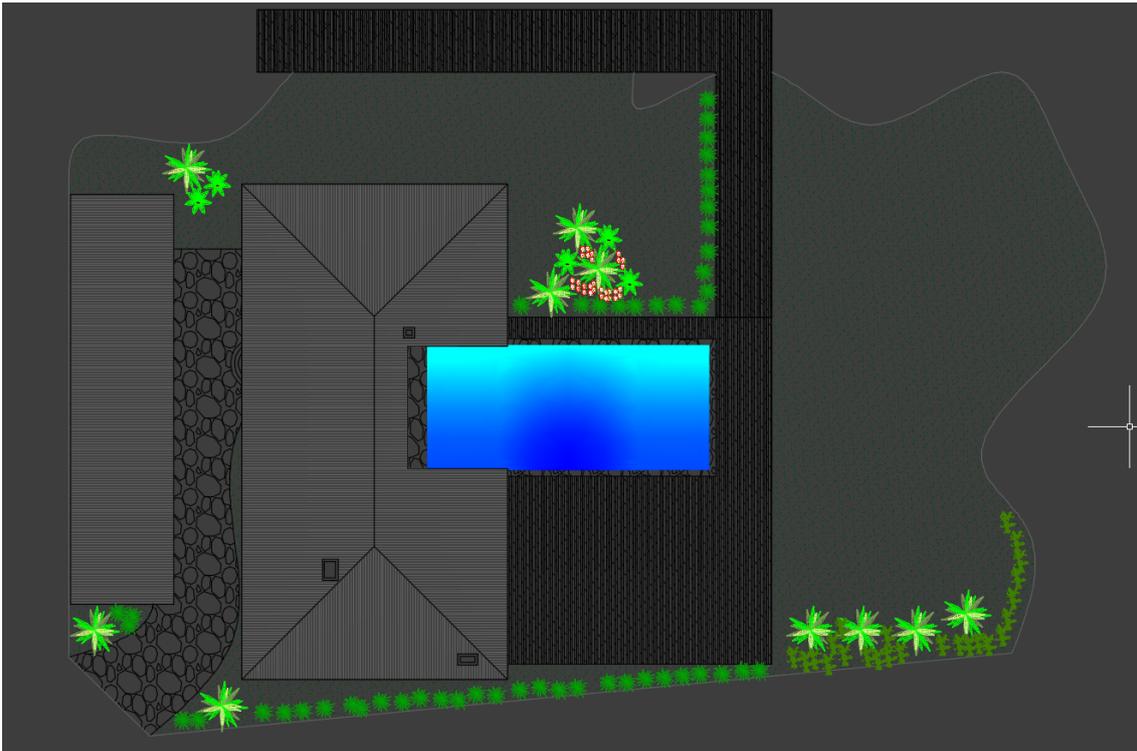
Projeto Arquitetônico – Planta Baixa Térreo/Cobertura
